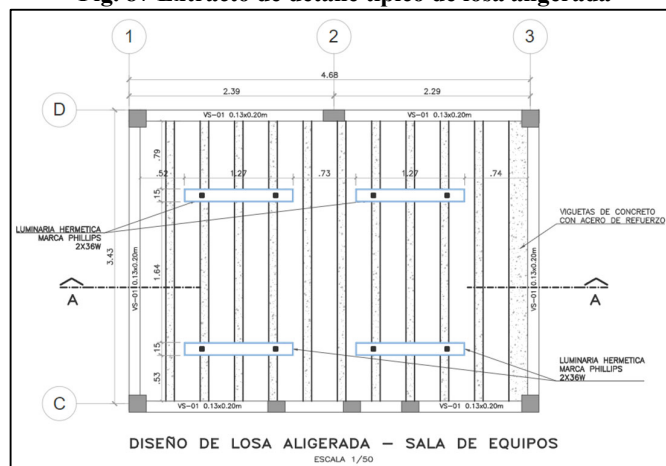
Plano de Losa Aligerada y anclaje de luminarias
